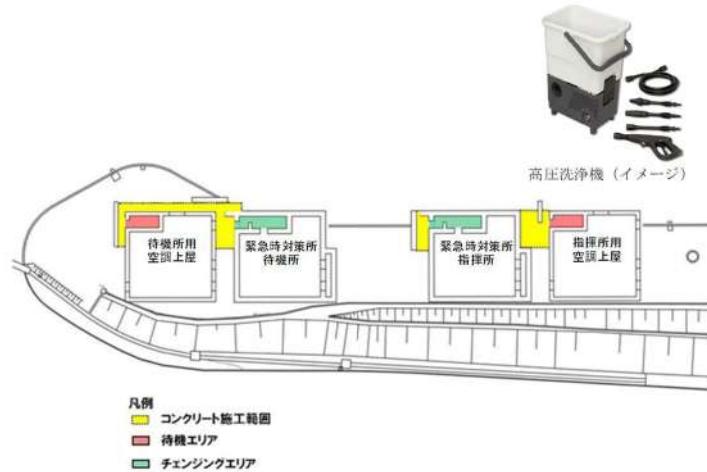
緊急時対策所周辺の地表面のコンクリート施工
